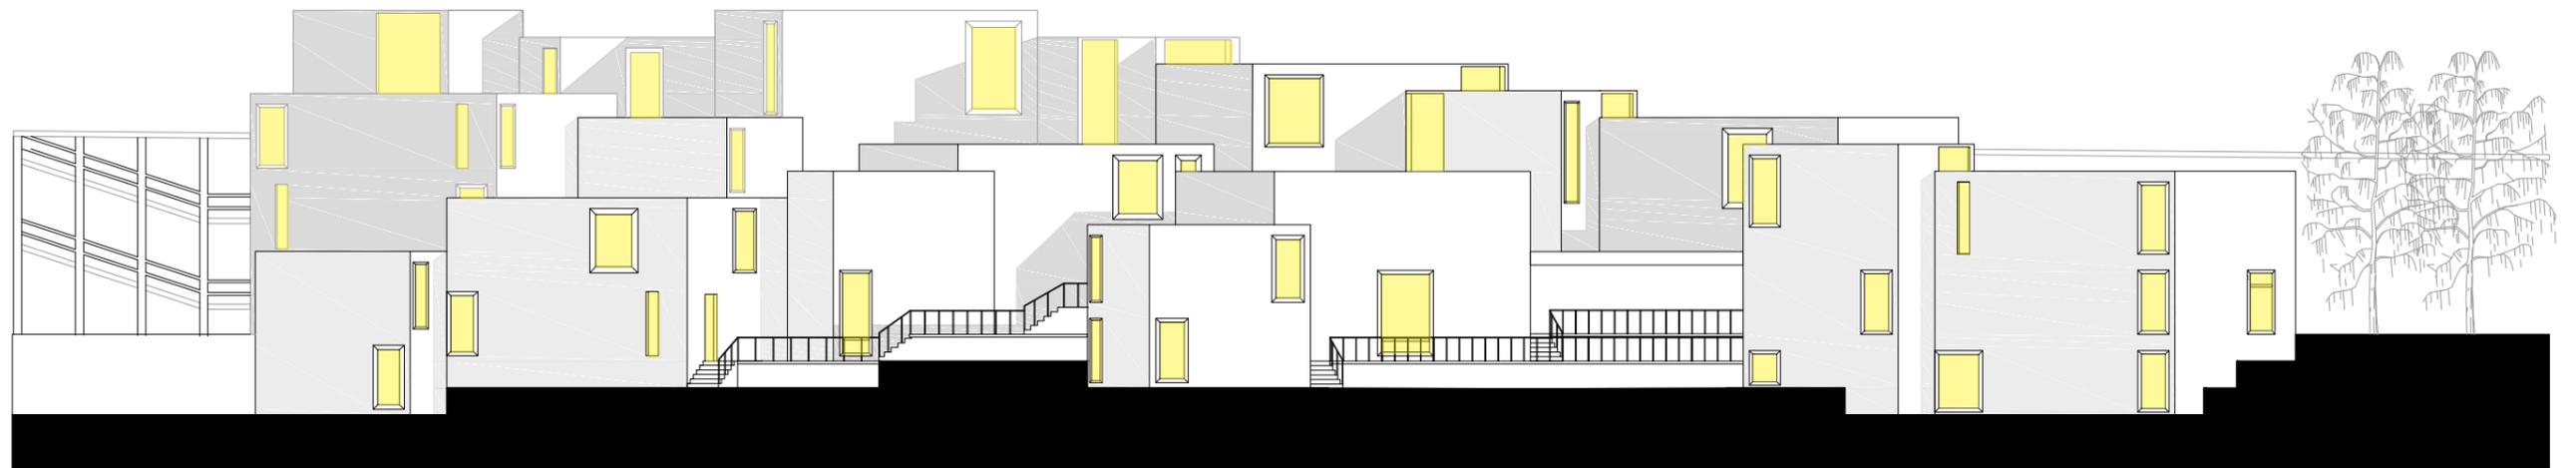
Esquema de iluminación fachada, Esc: 1:250
